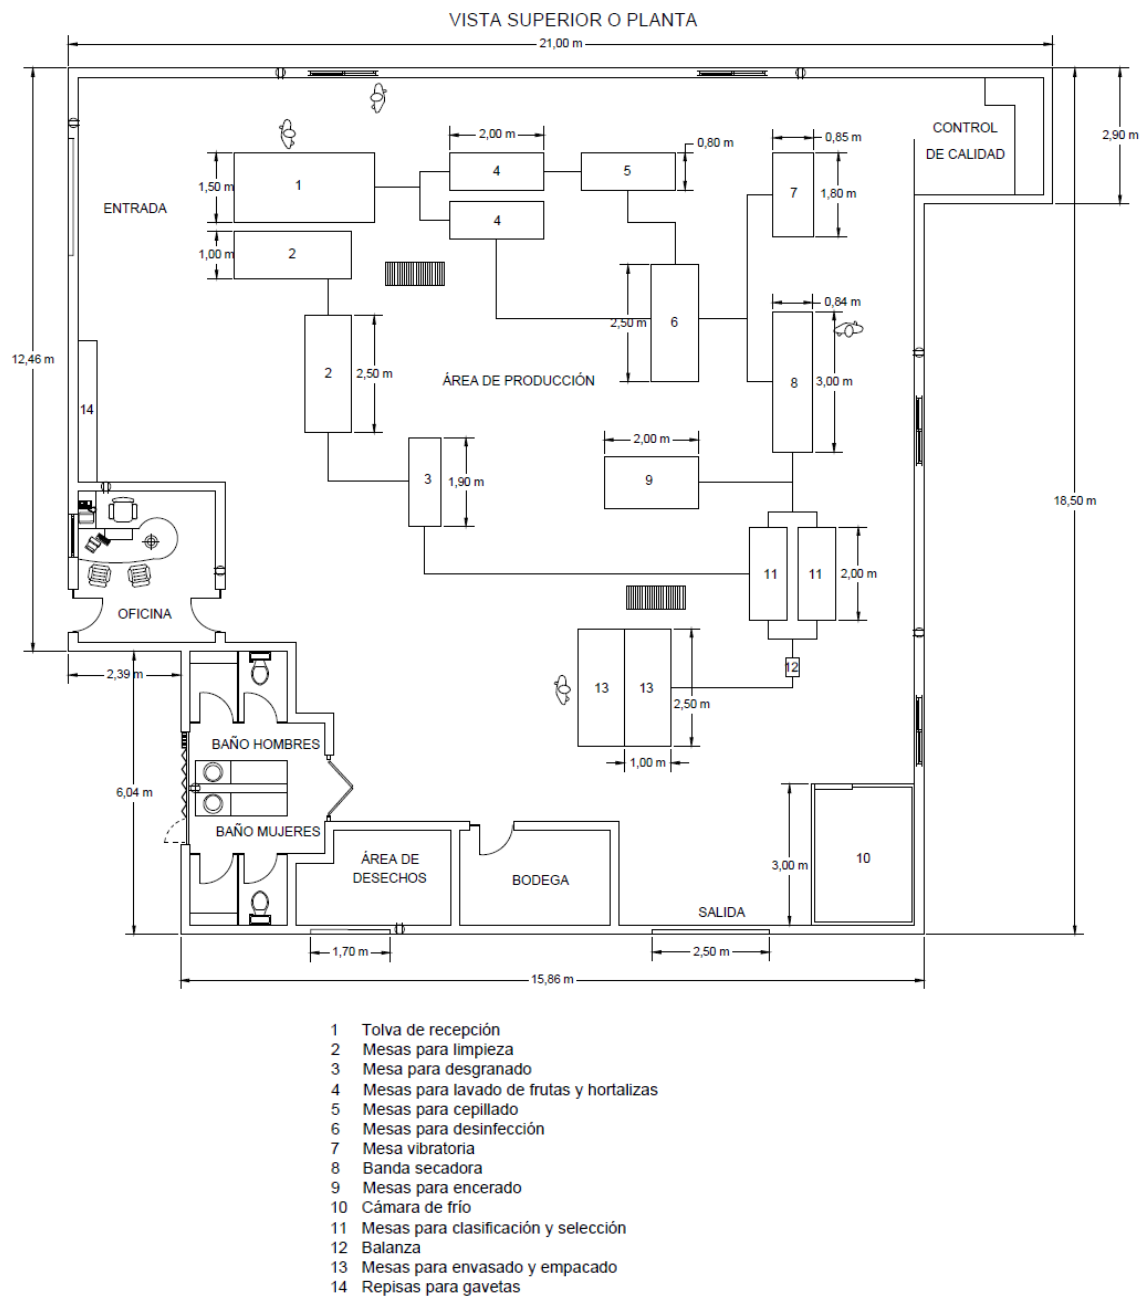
Plano Referencial de distribución de la planta poscosecha a escala 1:1
